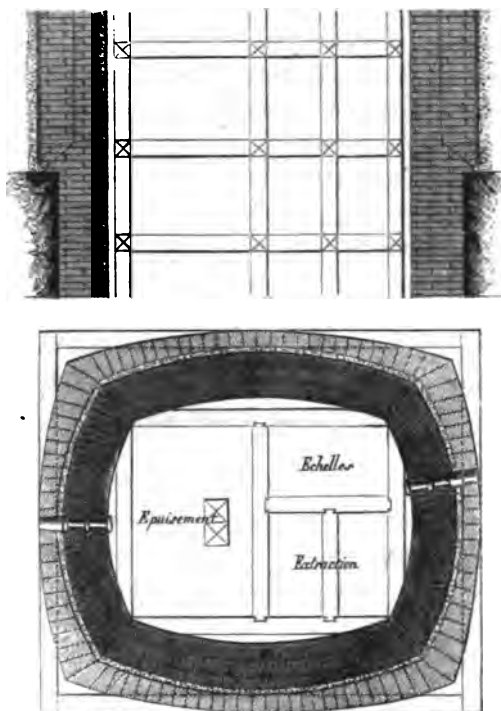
Plan et coupe d'un puits cuvelé en maçonnerie.
